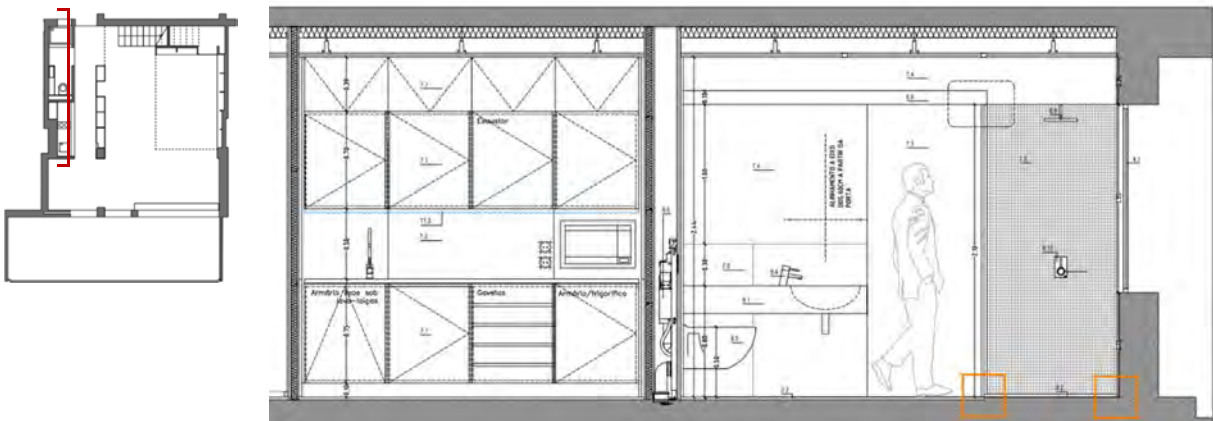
Corte Construtivo do volume da instalação sanitária e Kitchenette
